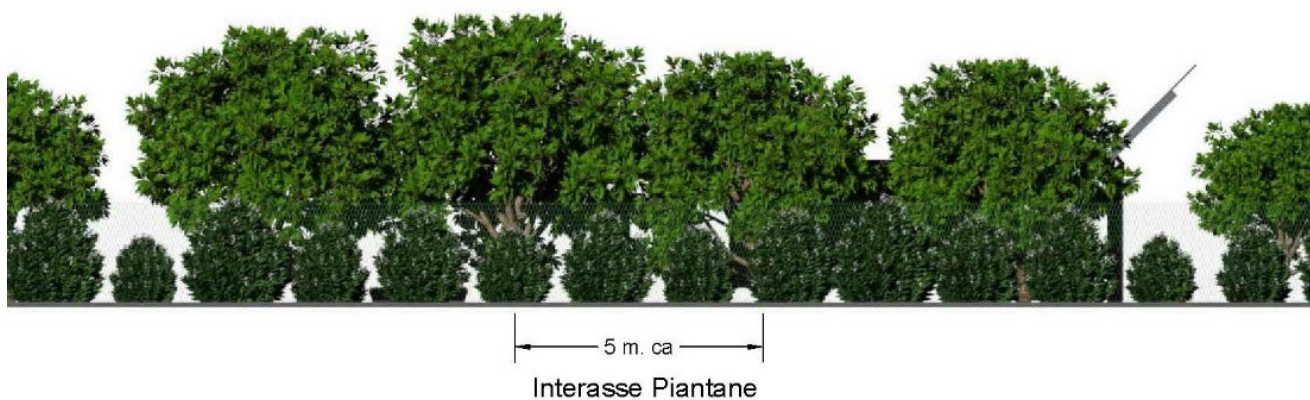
Prospetto recinzione perimetrale con mitigazione
